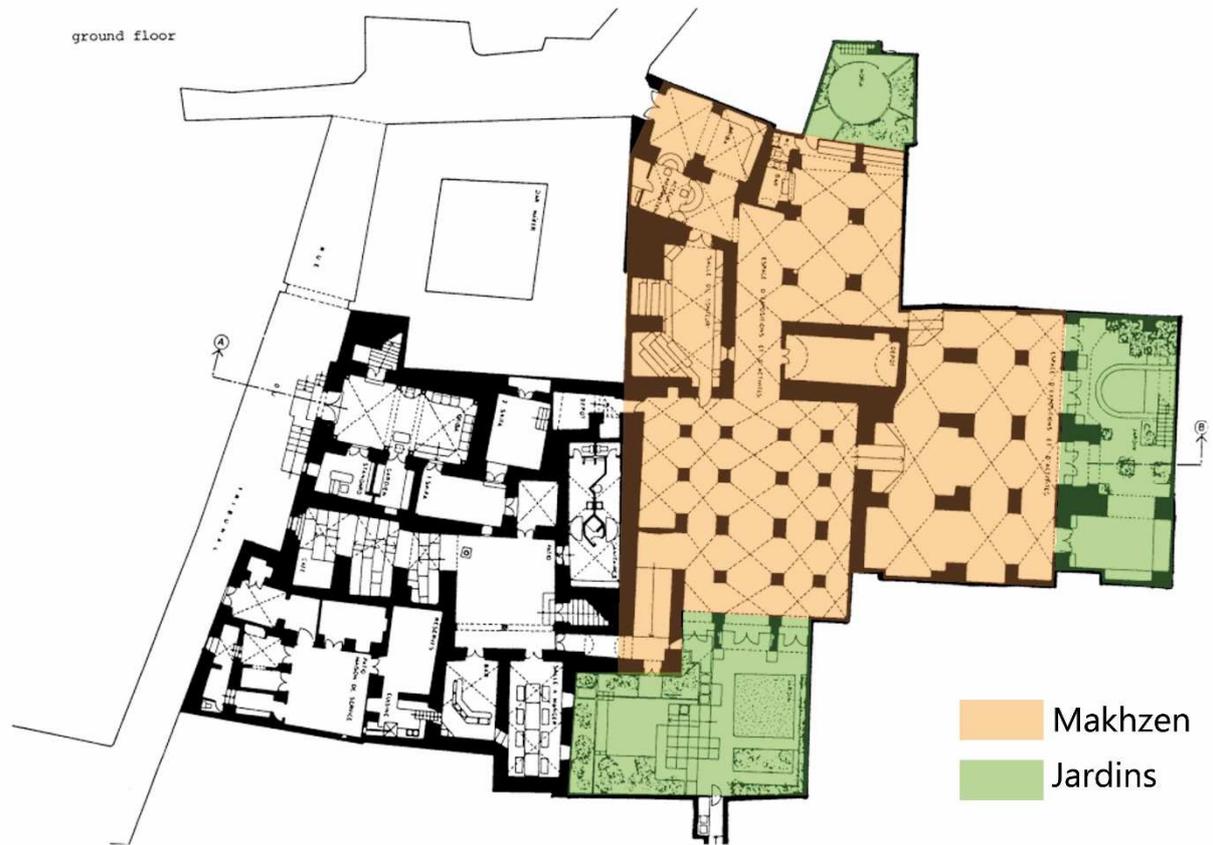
Plan du Makhzen après les travaux de reconversion
